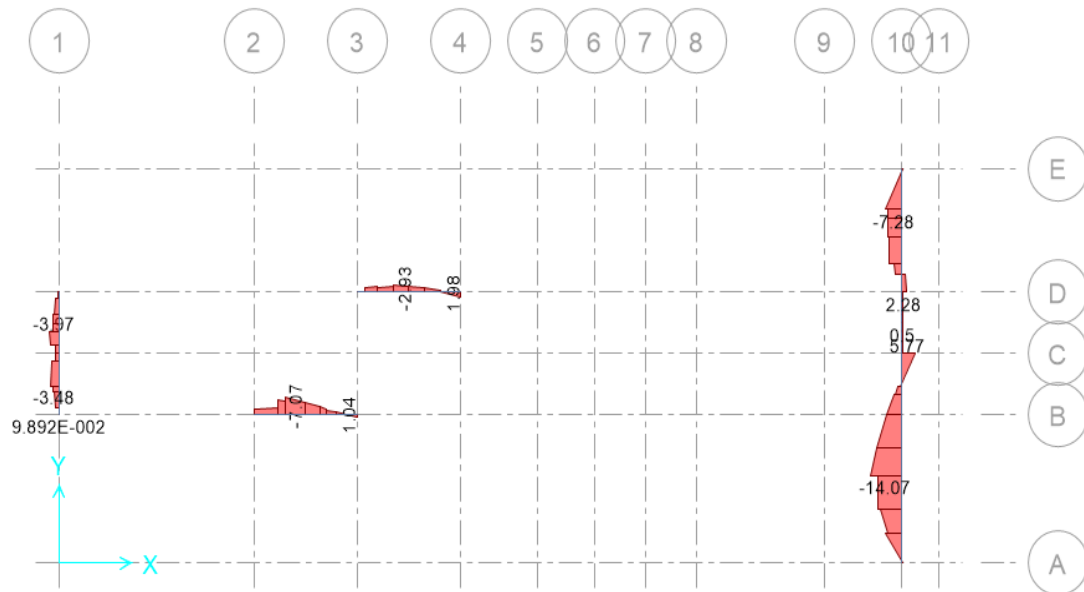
Momentos en Vigas de Cimentación (Ton-m)
